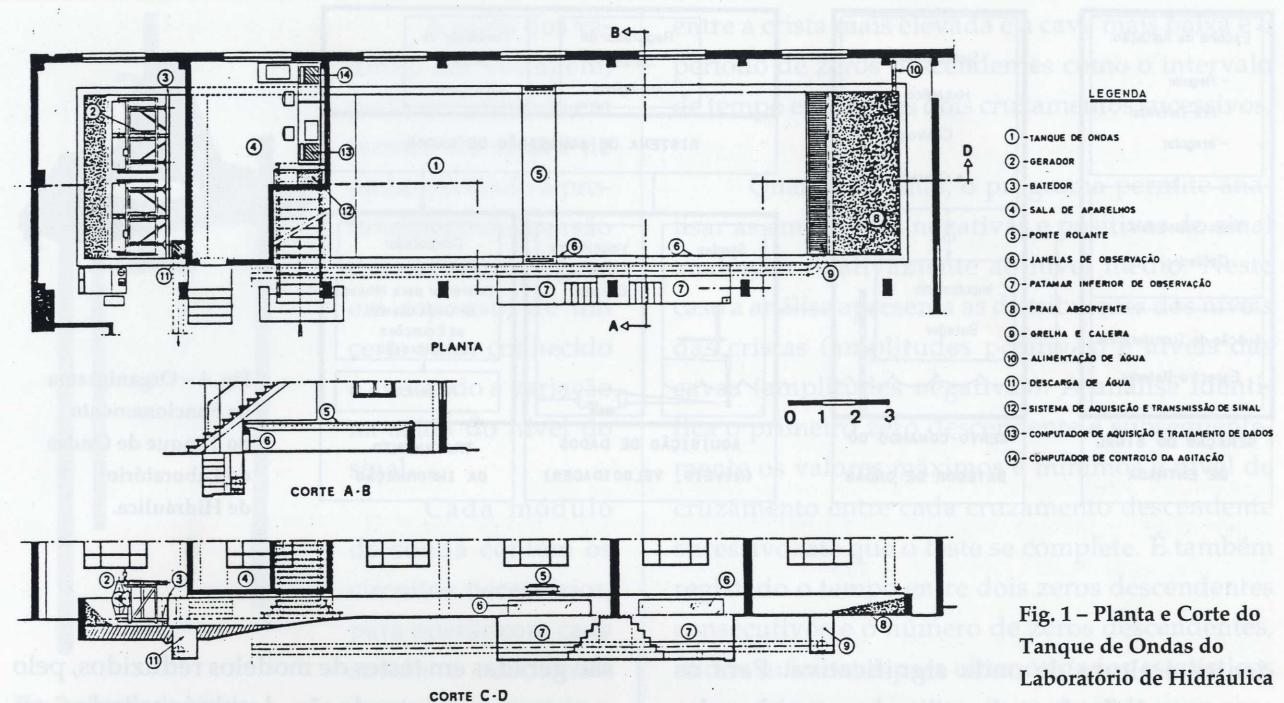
Planta e Corte do Tanque de Ondas do Laboratório de Hidráulica
